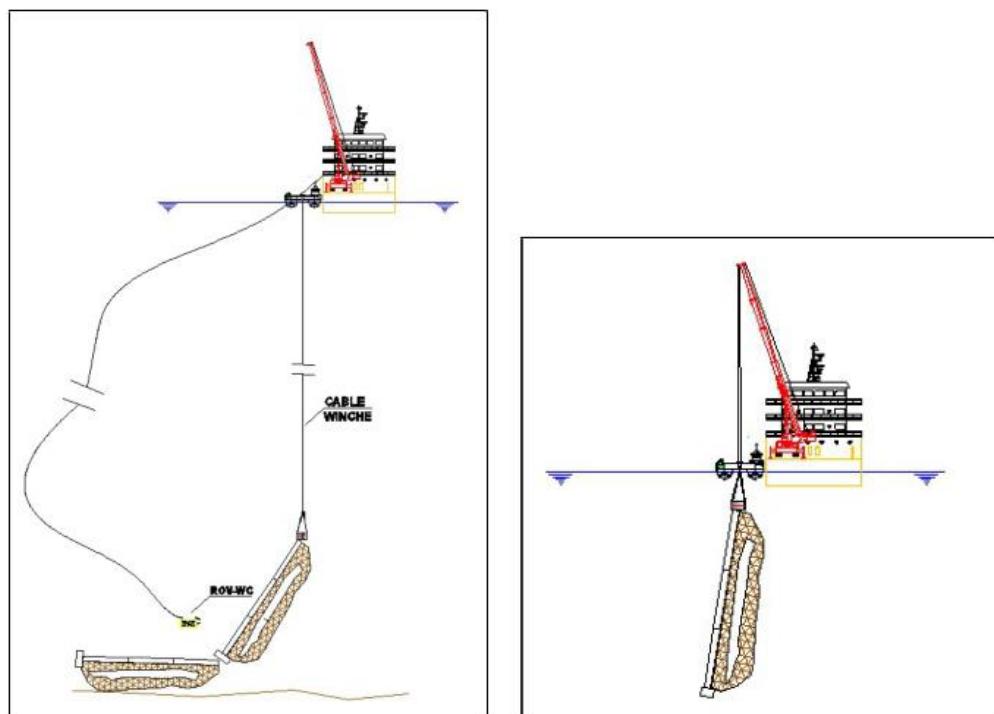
Maniobra de rescate planificada de jaulas siniestradas (Fuente: Estudio OXXEAN).
